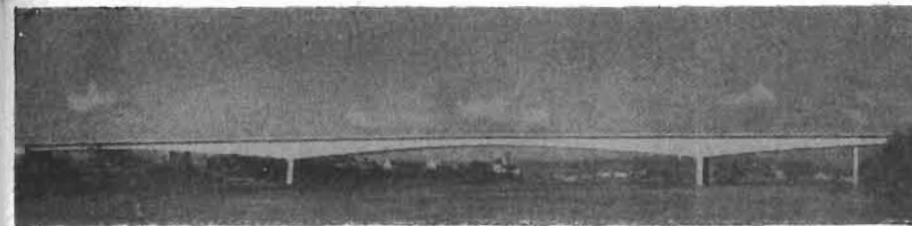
Vista parcial del puente Bendorf sobre el Rin en la autopista Montabaur-Koblenza.
